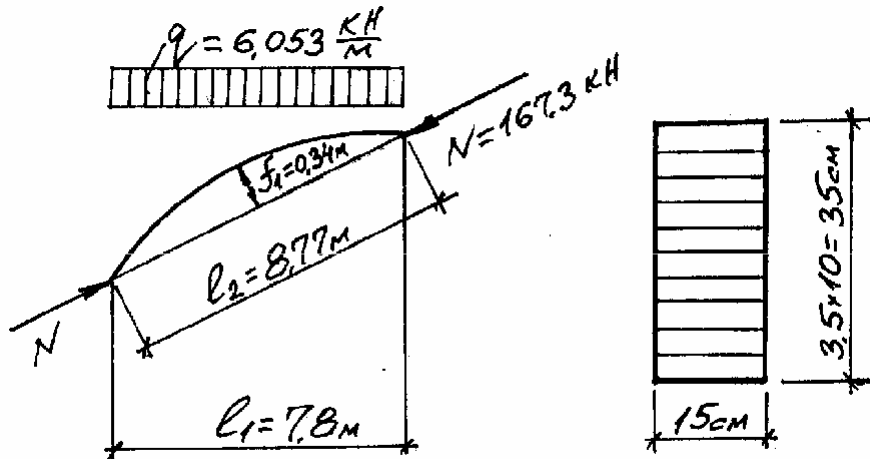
Розрахункова схема і переріз верхнього пояса
